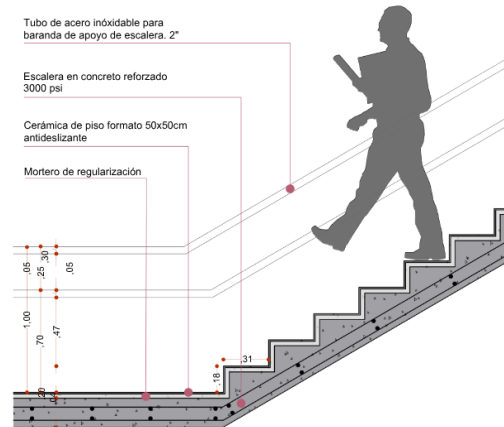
Detalle escalerasFigura 97. Análisis fachada norte
